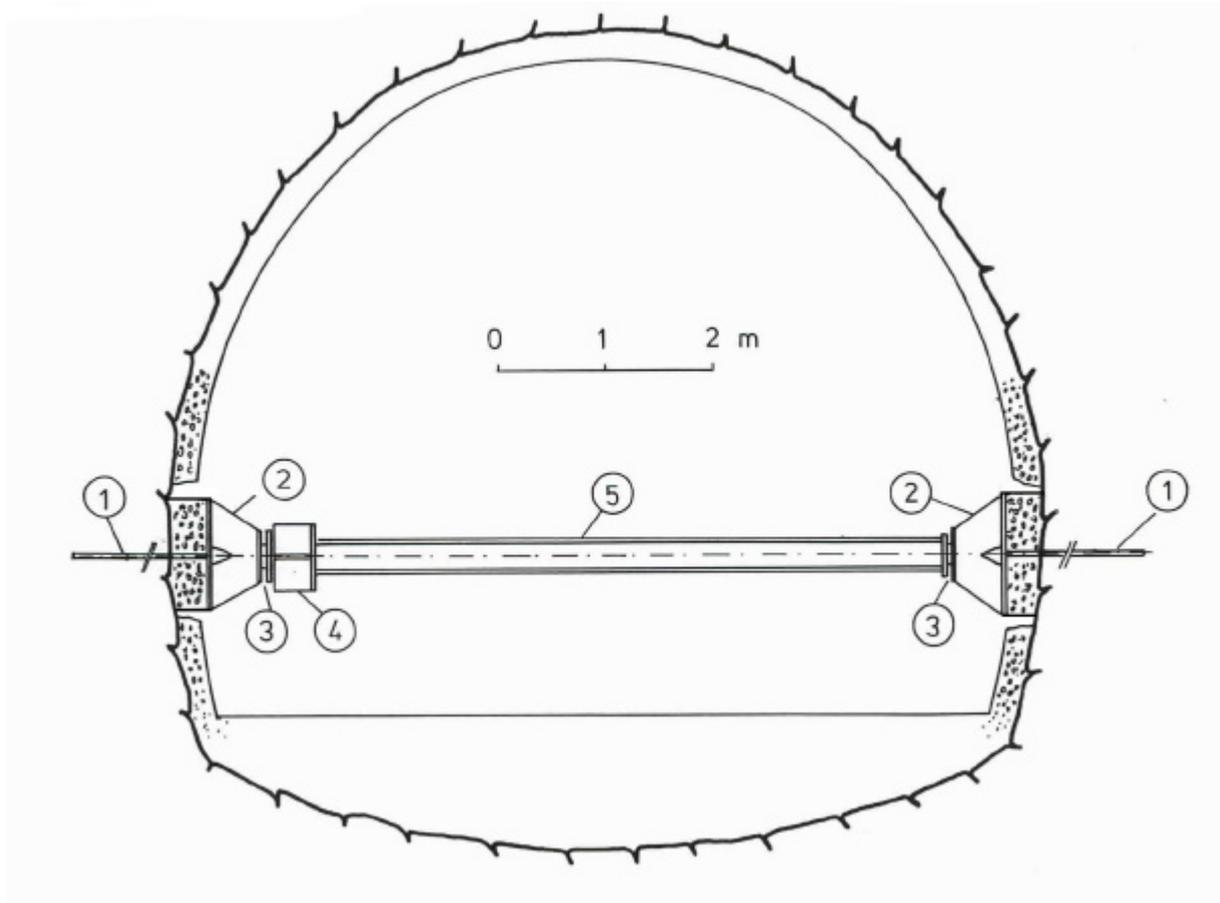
Essai de charge sur plaque dans la galerie d'accès du tunnel Landrücken
